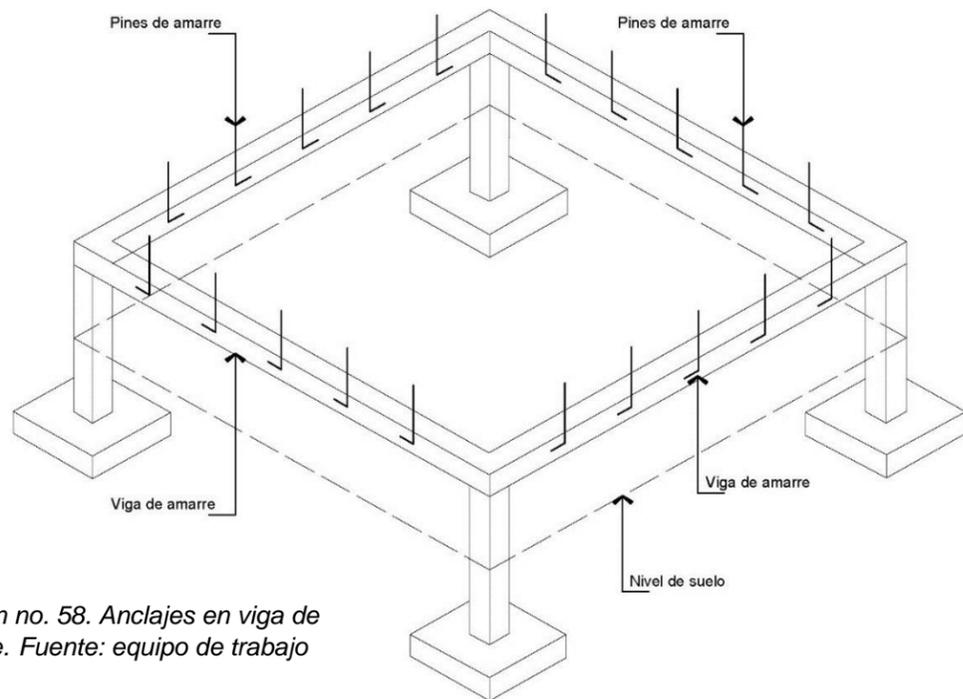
Anclajes en viga de amarre. Fuente: equipo de trabajo
